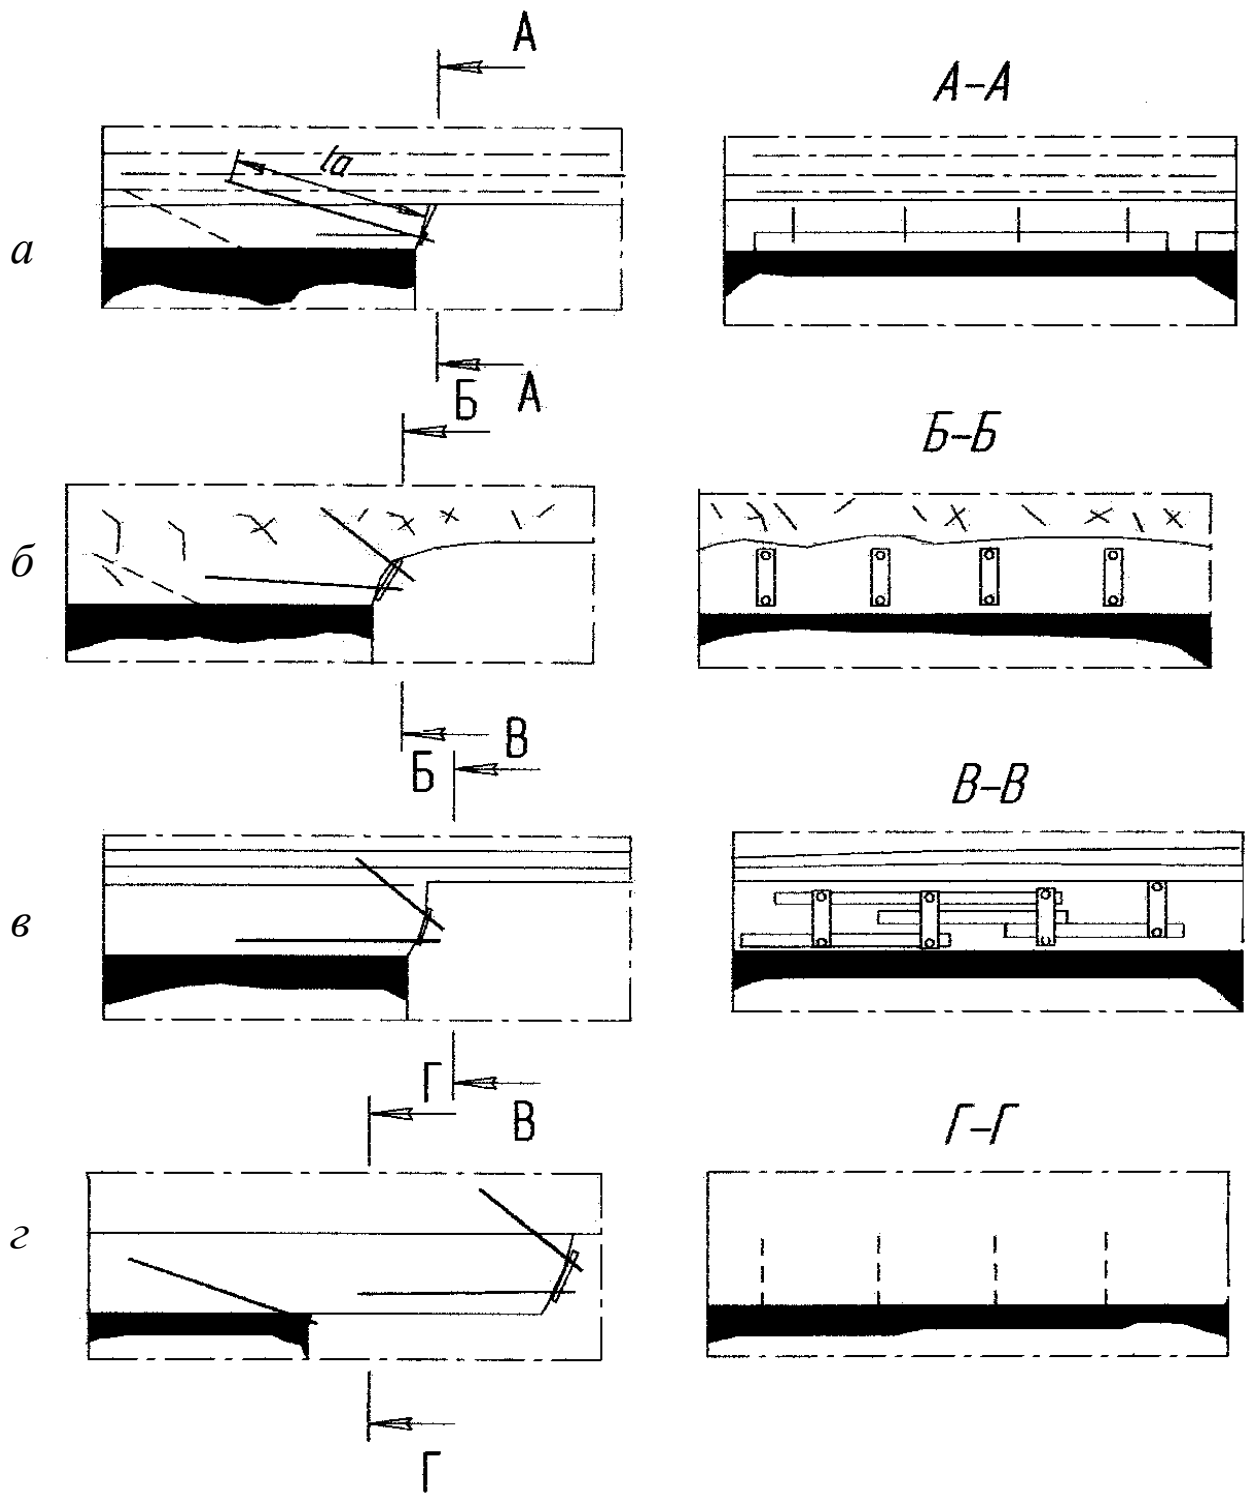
Схемы химического анкерования неустойчивых пород кровли
